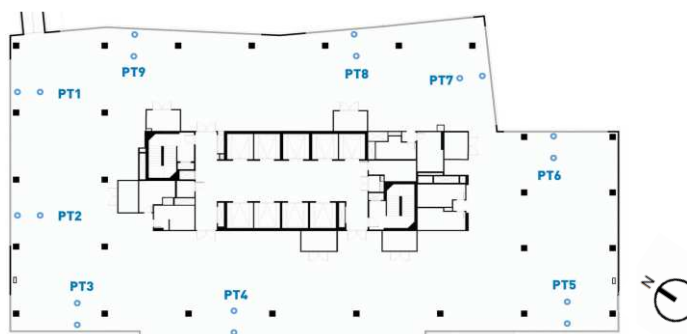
planta do pavimento com localização dos pontos de análise. (LUIZ; MANFREDINI, 2020)
